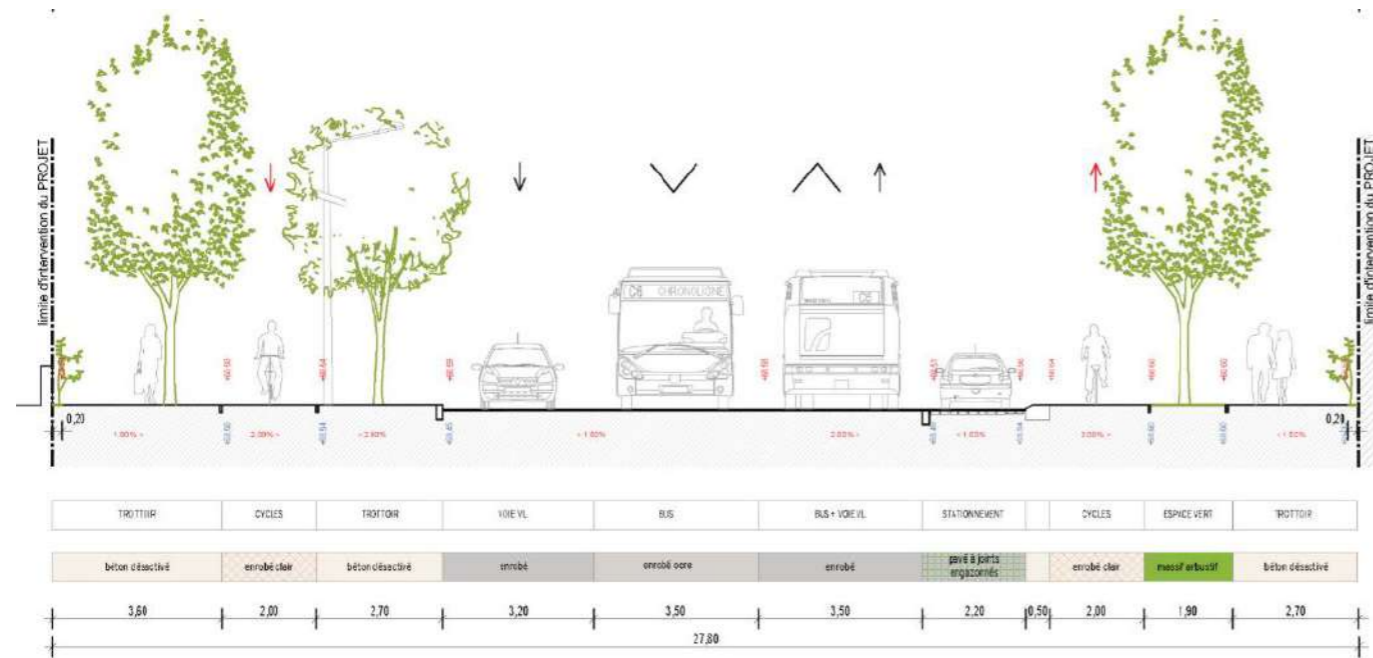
Profil futur de l'Avenue Bollée - Nord
